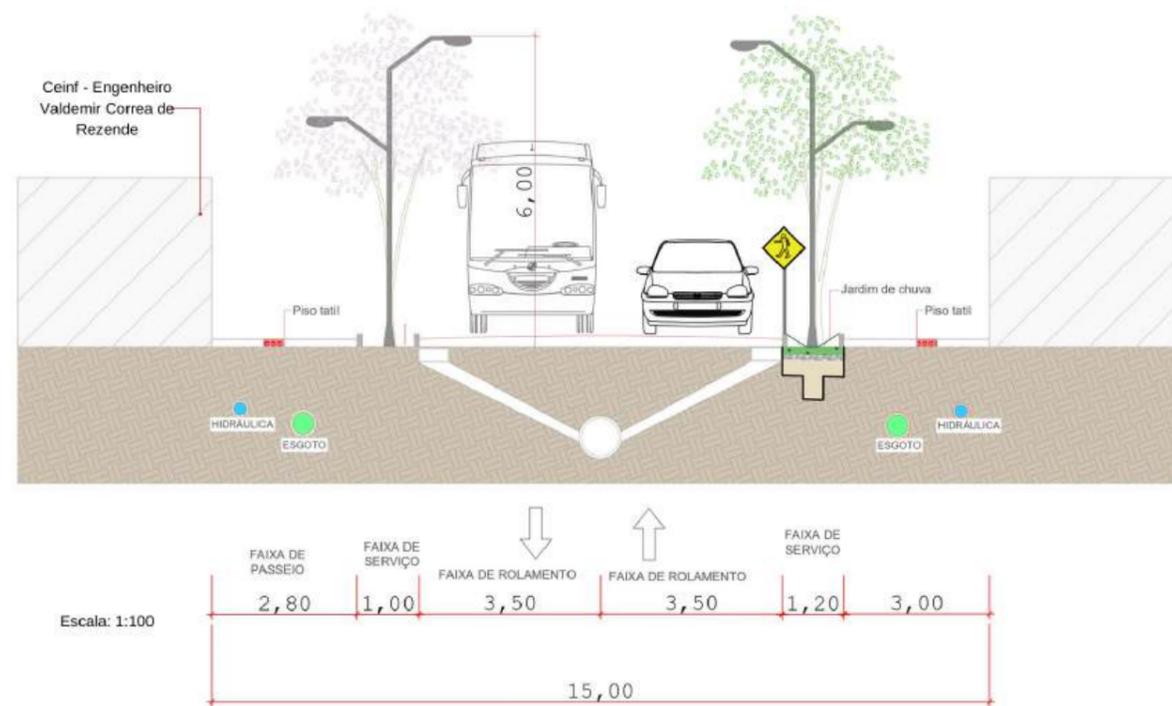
Planta baixa da proposta do trecho entre a Rua Catiguá e a Rua dos Topógrafos
